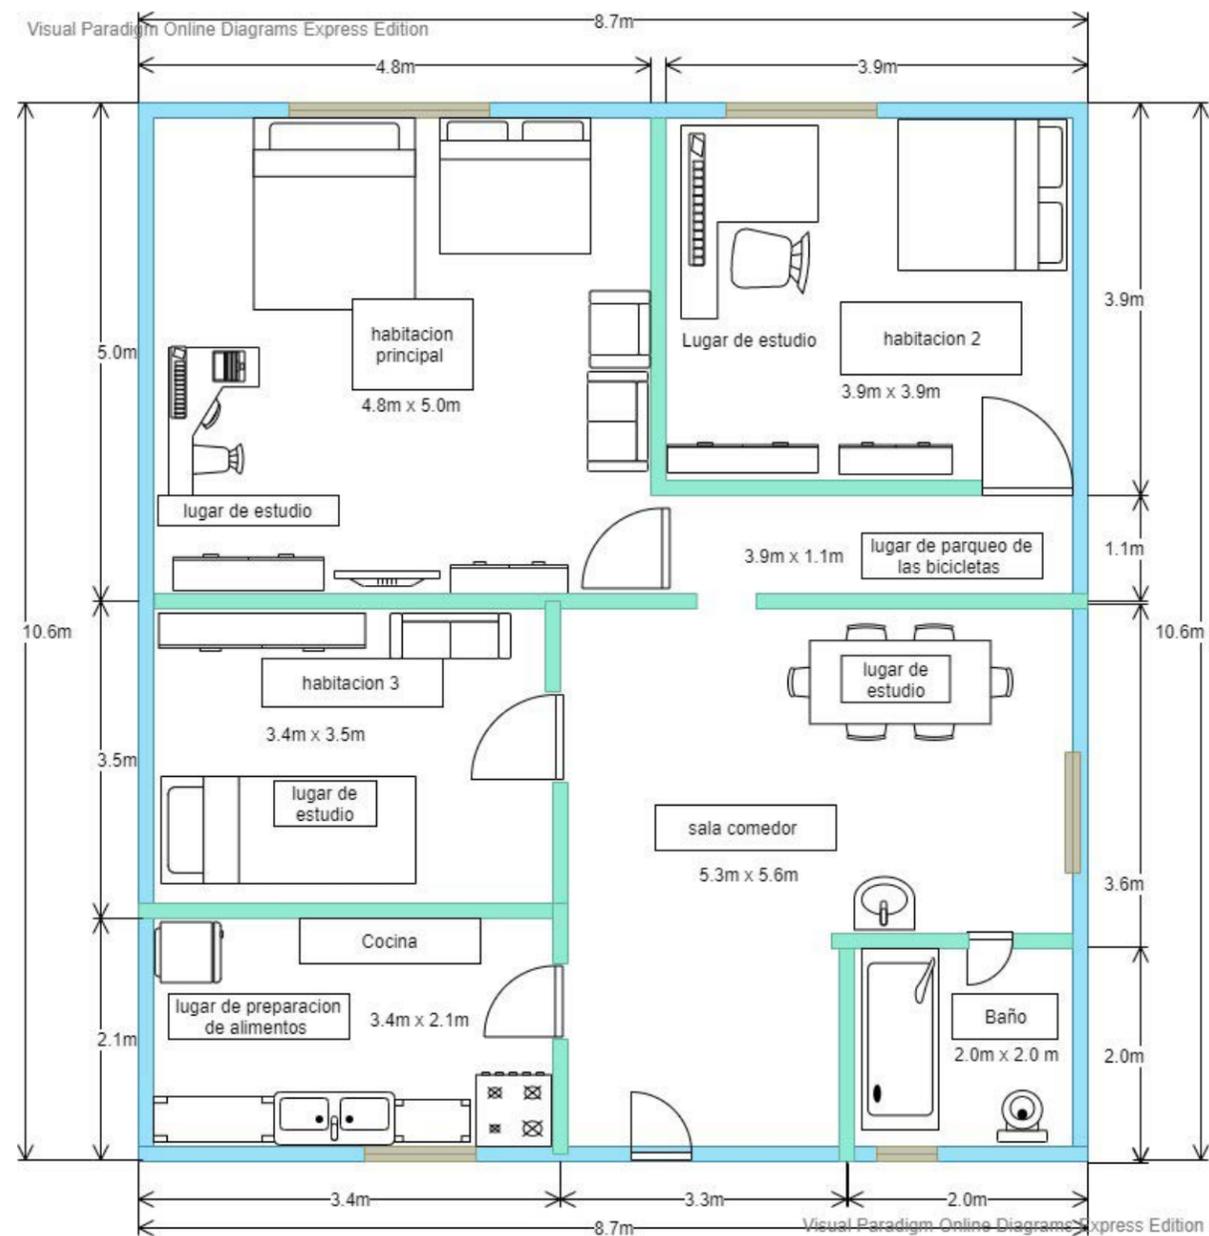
Plano apartamento, zonas de estudio, Daniel Gaitán Pérez.
